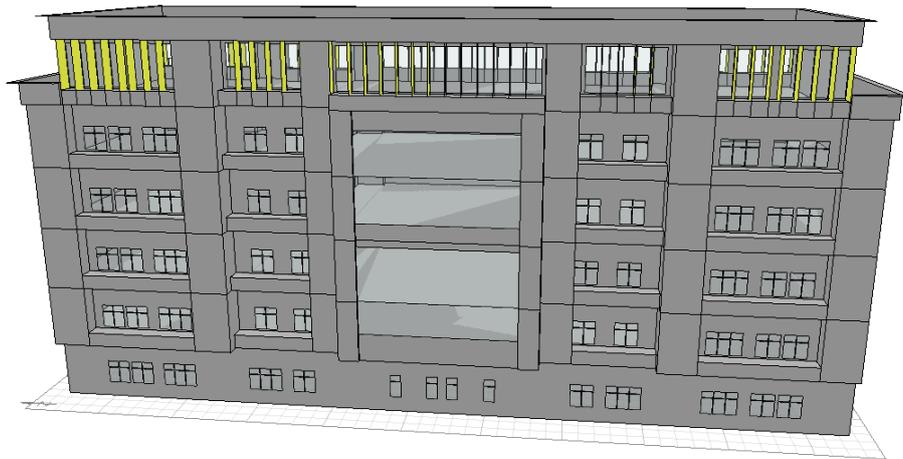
Keyplan jendela kaca tipikal lantai 4-7
